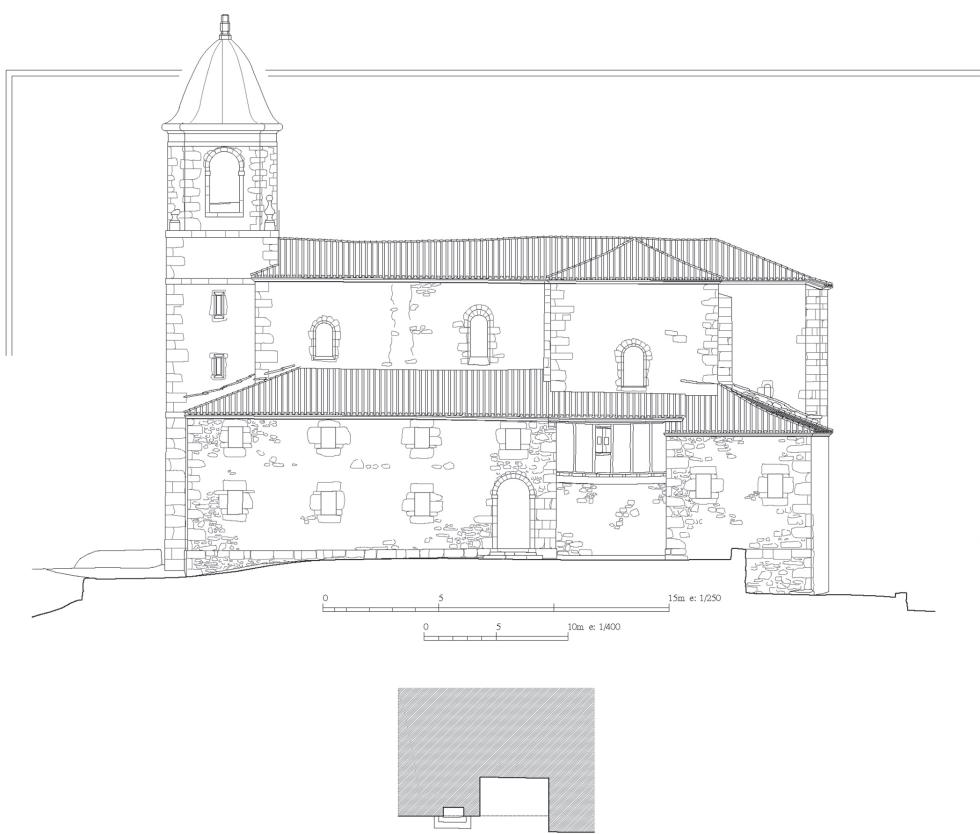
Planta y alzados de la casa Serorategia (Berroeta). / Elevation and plan of the house Serorategia (Berroeta).
